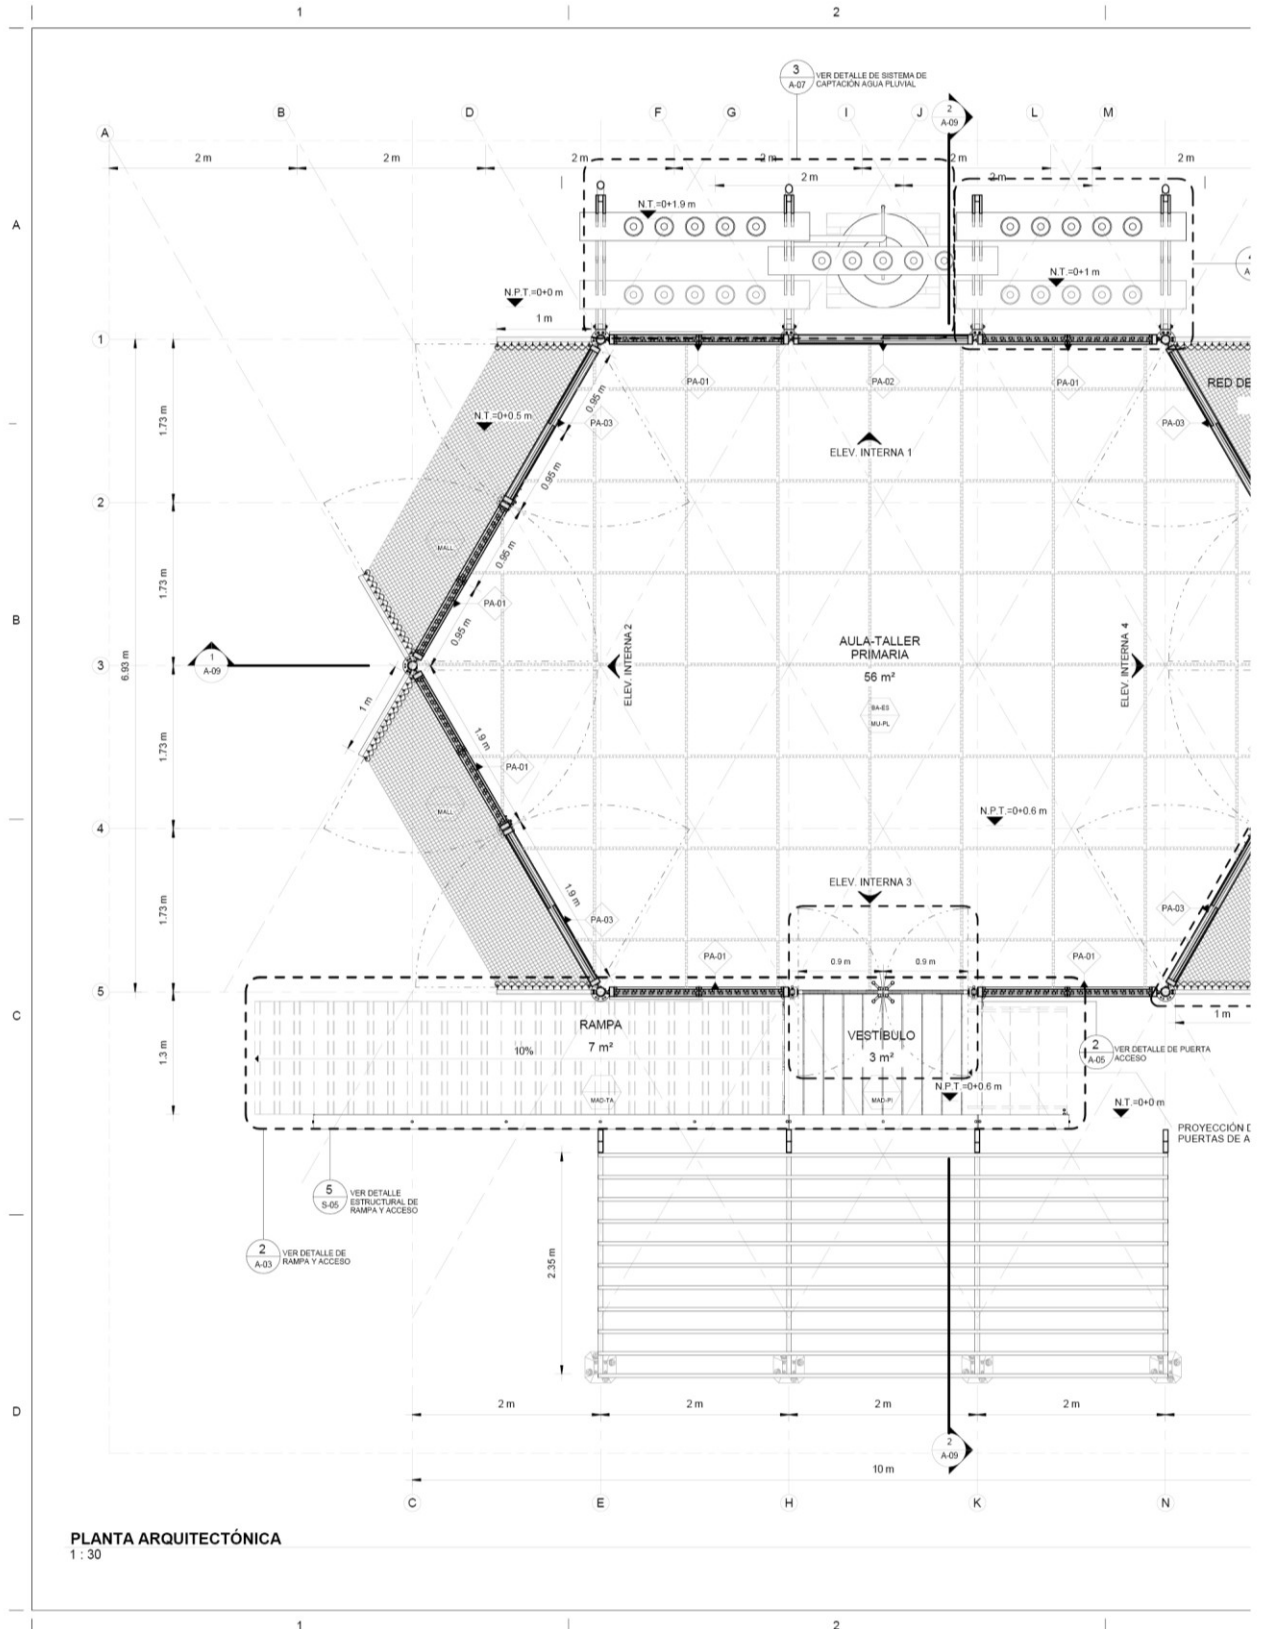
Lámina 02, planimetría de tipología B.<sup>311</sup>
